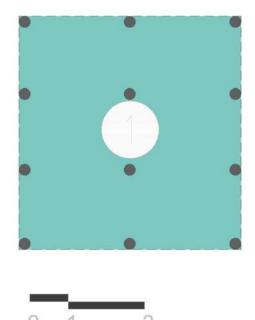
Planta 1 Bloque 49. Fuente: Equipo de diagnóstico.
